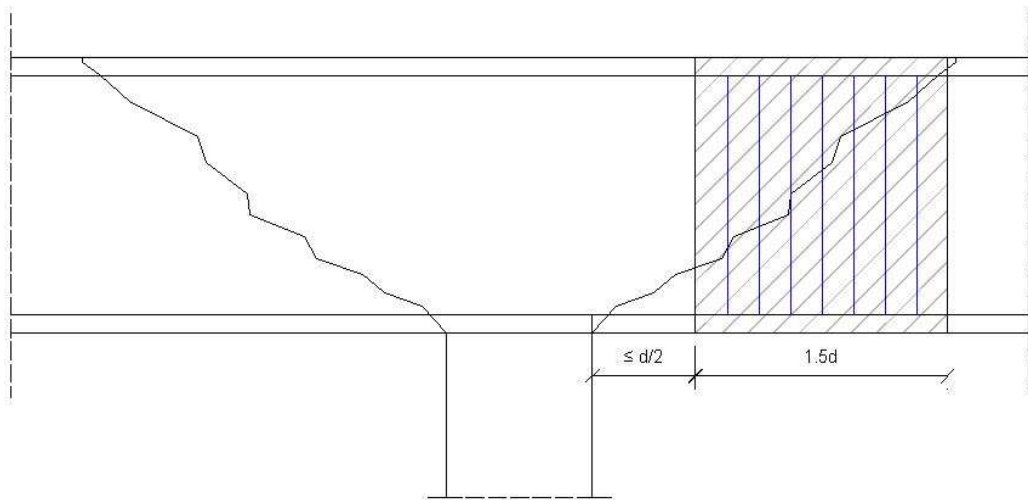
Disposição da armadura de punçoamento em corte.
